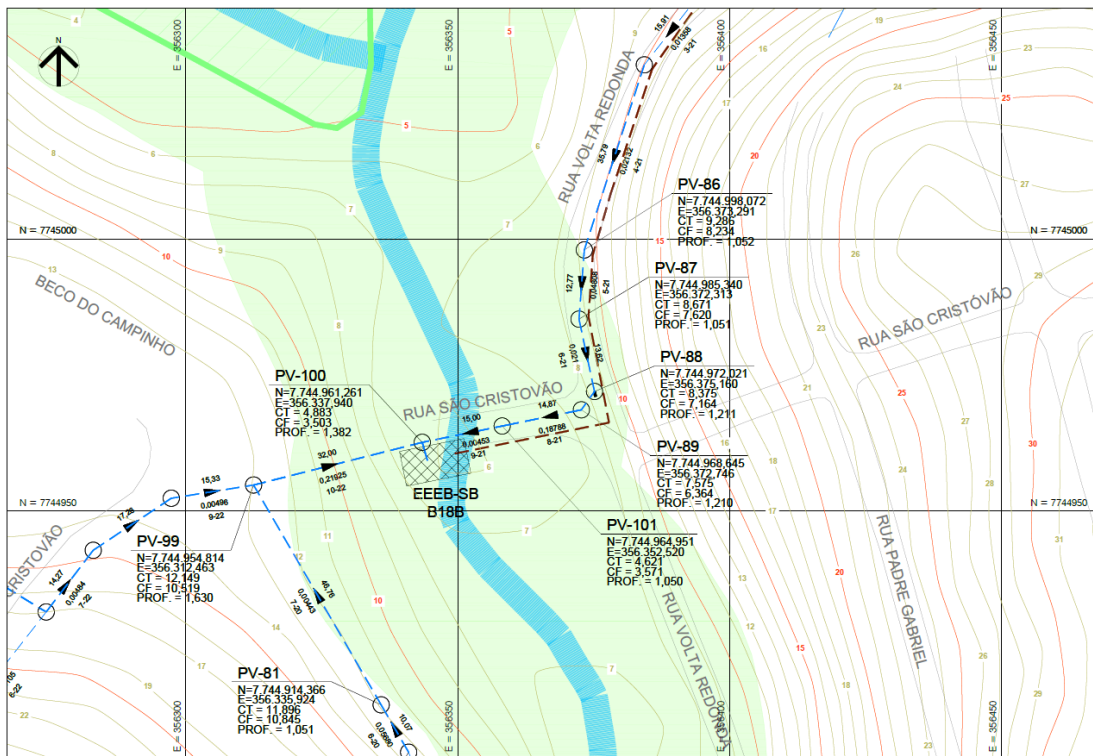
Estação elevatória de esgoto bruto EEEB-SB-B18B, em área de APP.
